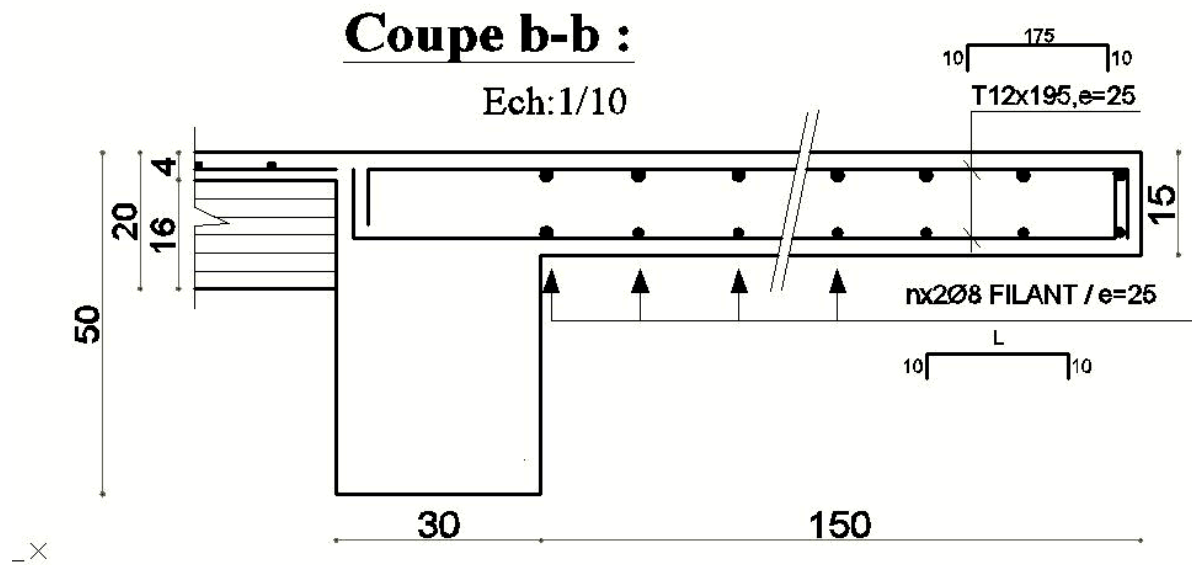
N°07: Schéma de ferrailage du balcon type 01.
